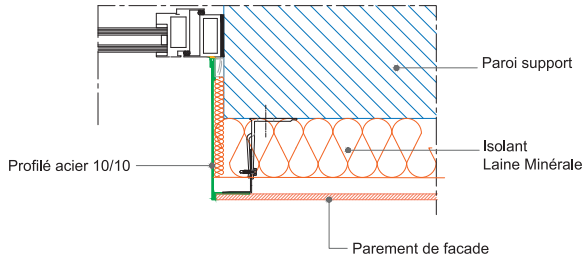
Coupe horizontale encadrement de la baie niveau tableau
